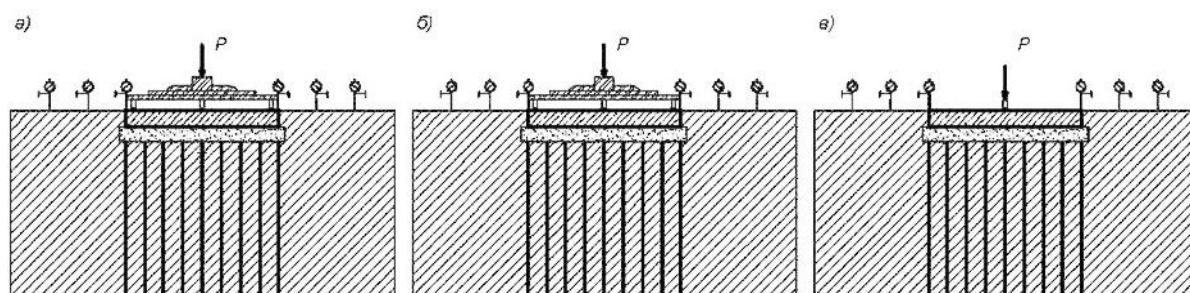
Схемы армирования и нагружения грунтовых оснований:
